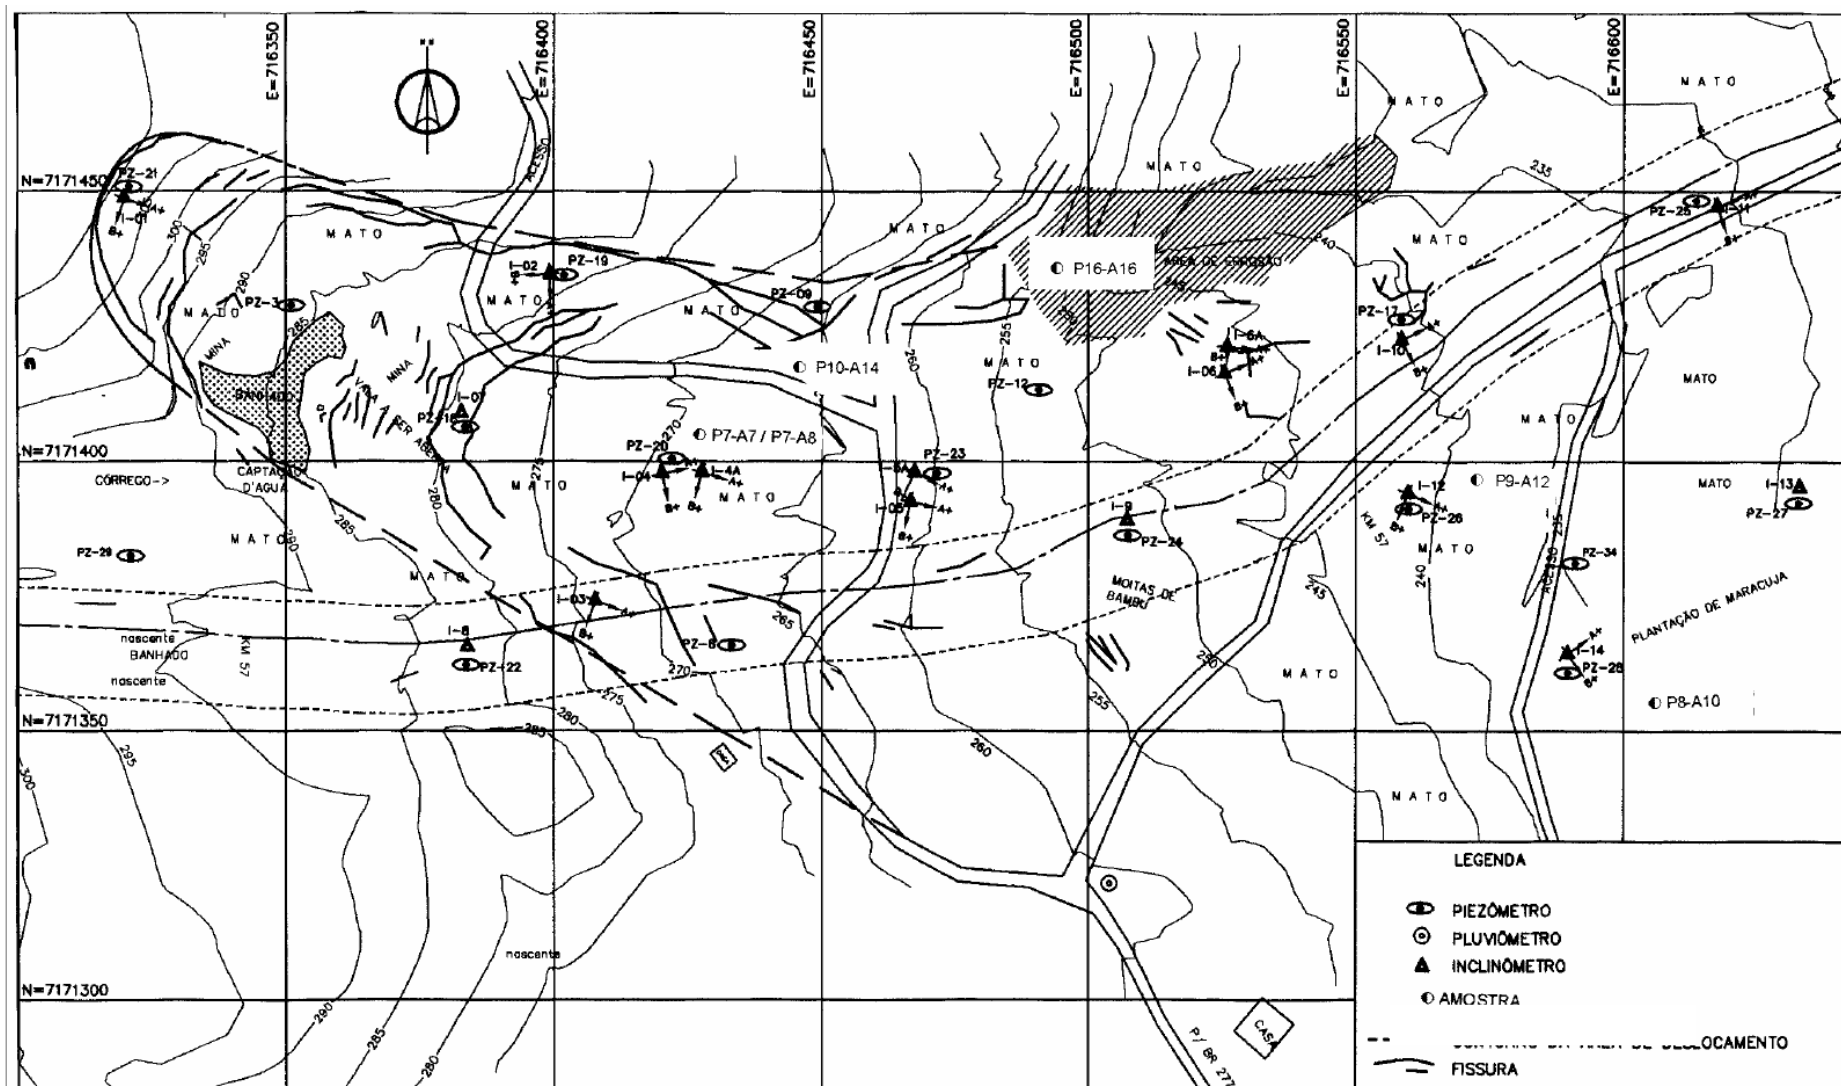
Planta topográfica da encosta OLAPA – instrumentação.
